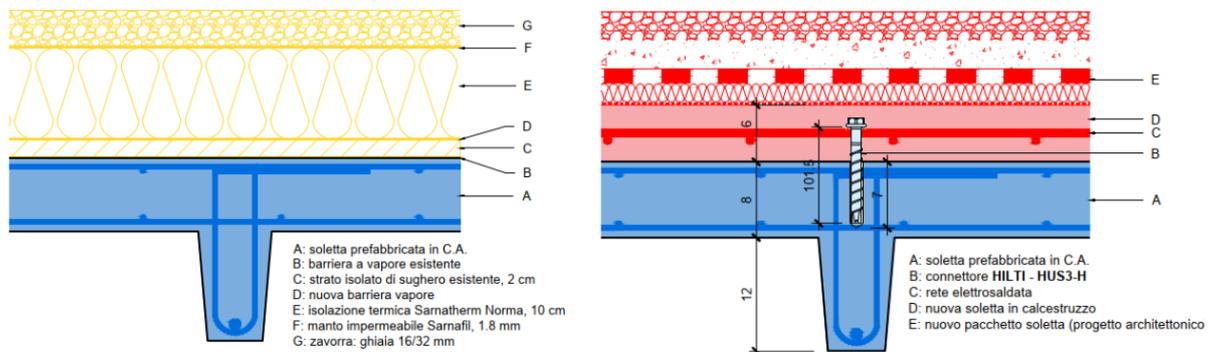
Porticati nord/sud: (sinistra) Dettaglio palconcello porticato e pacchetto tetto prima dell'intervento di rinforzo. (destra) Dettaglio palconcello porticato con cappa di rinforzo e nuovo pacchetto tetto (progetto architettonico ancora da definire).
